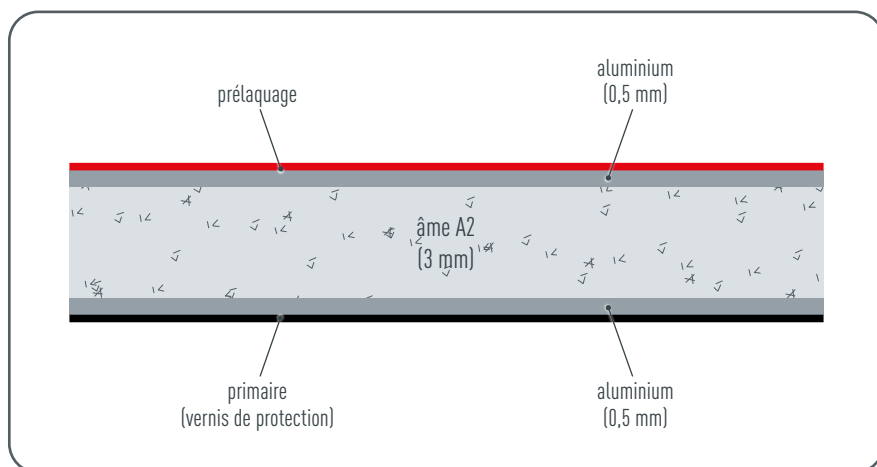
Structure du panneau composite PREFABOND avec âme A2
